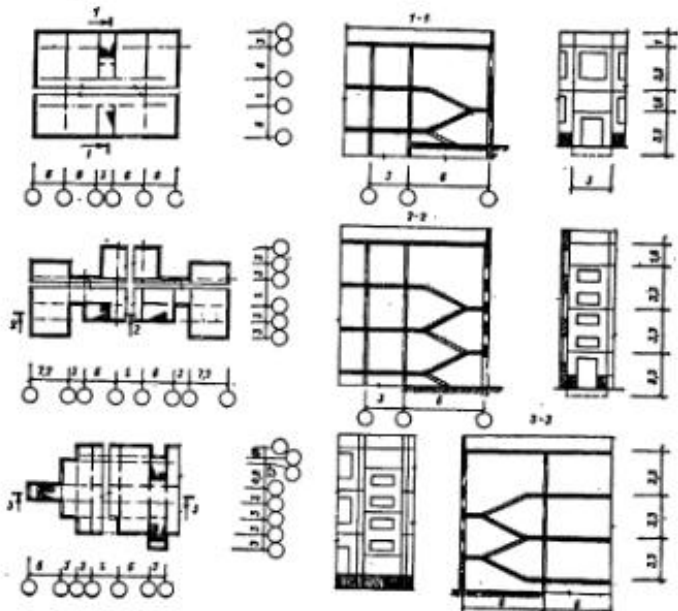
Примеры размещения, схемы разрезов и фасадов лестничных клеток в панельных общественных зданиях
